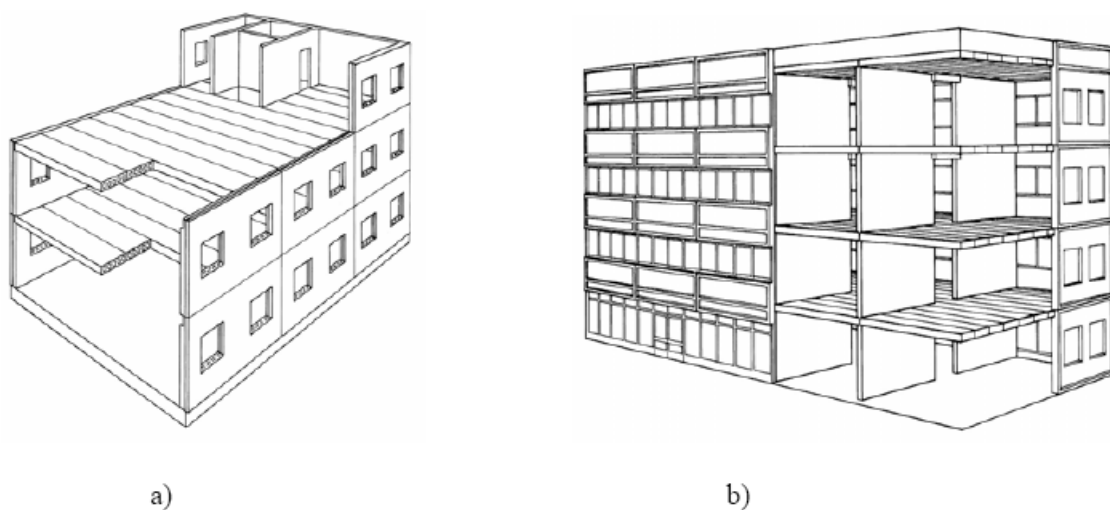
Exemplos de sistemas de parede, a) paredes de fachada, b) paredes de suporte de carga (FIB, 2008)
